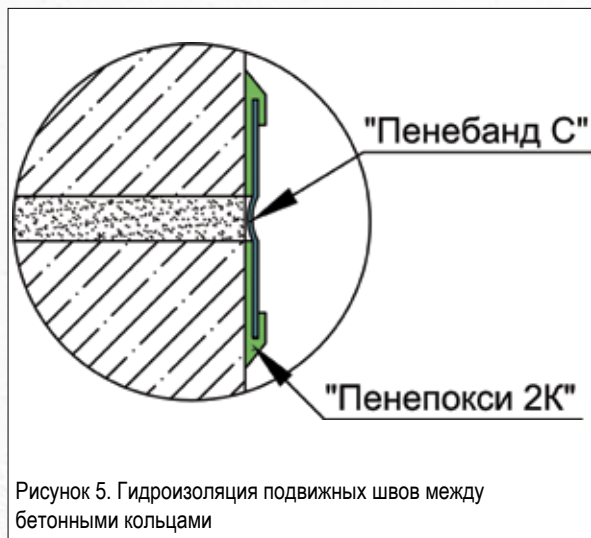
Гидроизоляция подвижных швов между бетонными кольцами
